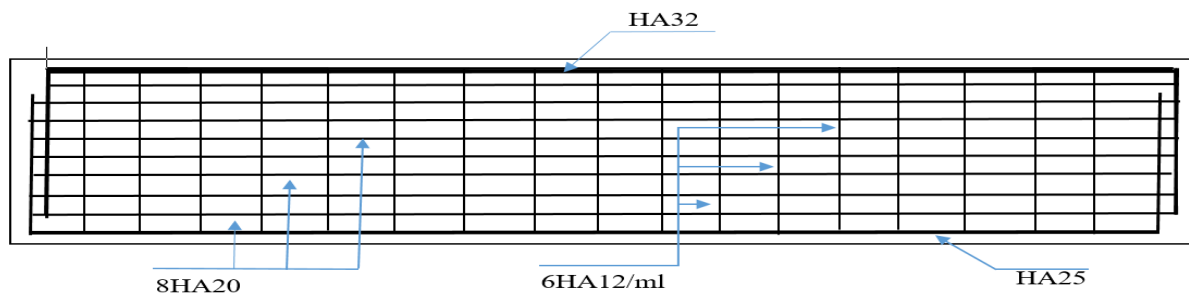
FERRAILLAGE DE CHEVETRE
